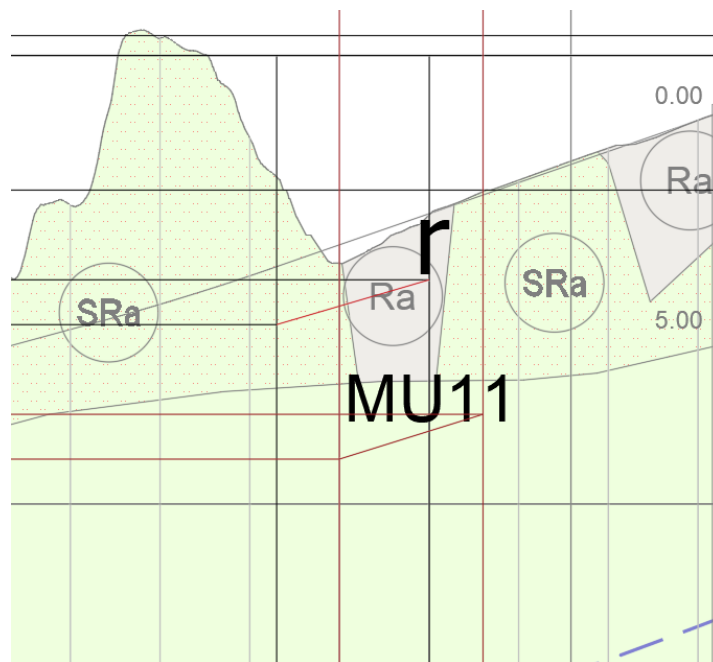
Stralcio profilo geotecnico con ubicazione muro in esame
